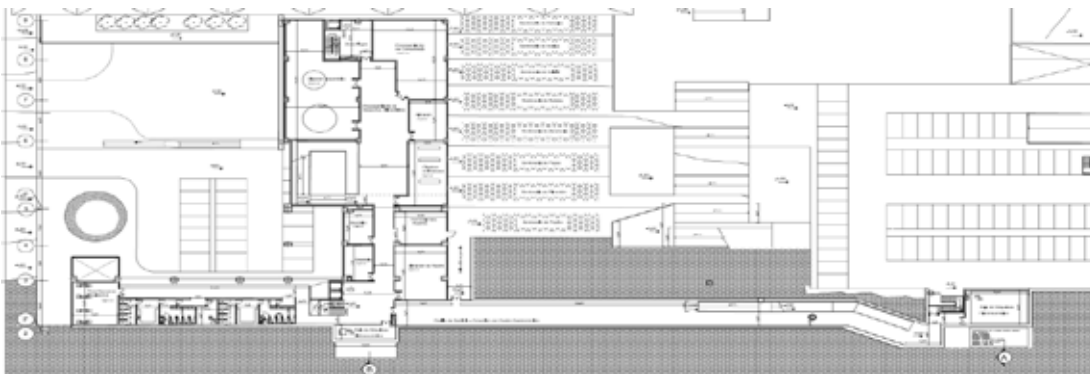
Vista Planta Nivel -3.00 - Malavé (2017)
